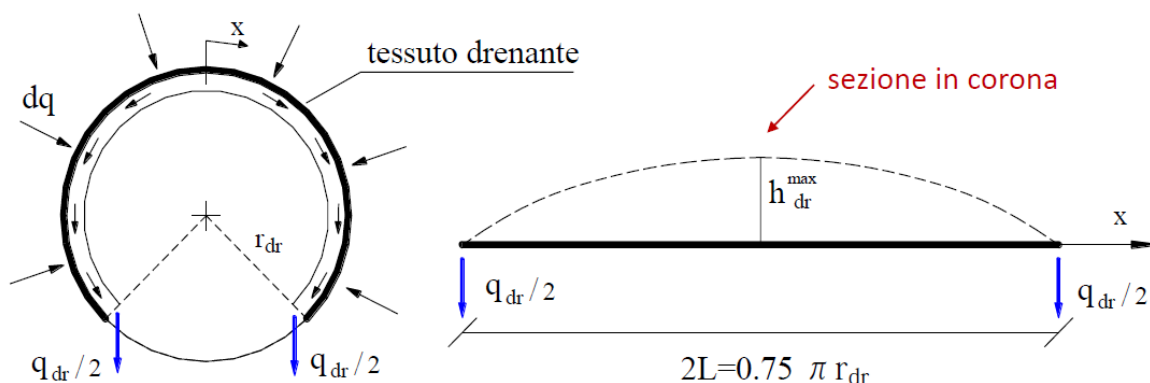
Schema di calcolo del flusso nella sezione con drenaggi
